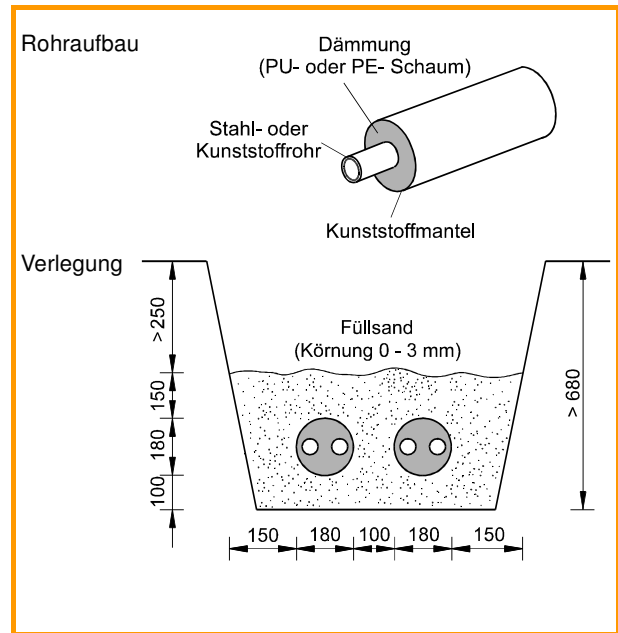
Bild oben: Prinzipieller Aufbau eines Fernwärmehres (Monorohr), Bild unten: Erdverlegung zweier Duo-Rohrleitungen für Nahwärme- sowie Brauch- und Trinkwasserversorgung (Maße in mm) (nach /6-32/)
